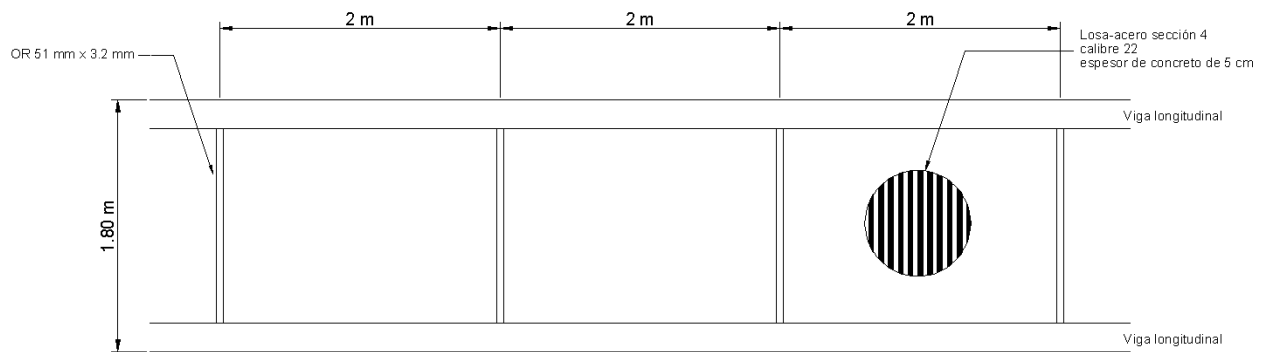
Sujeción lateral del puente peatonal tipo (vista en planta)
